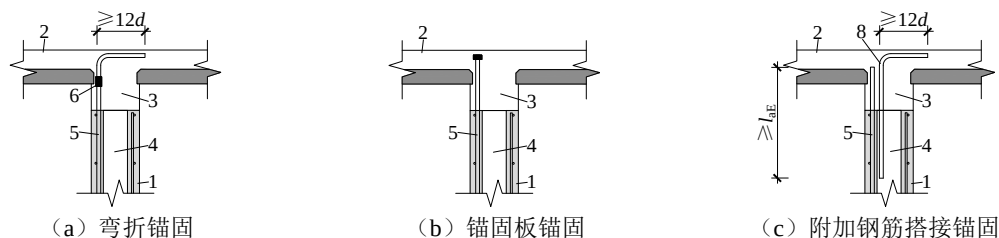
空心叠合剪力墙墙身竖向钢筋顶部构造示意
